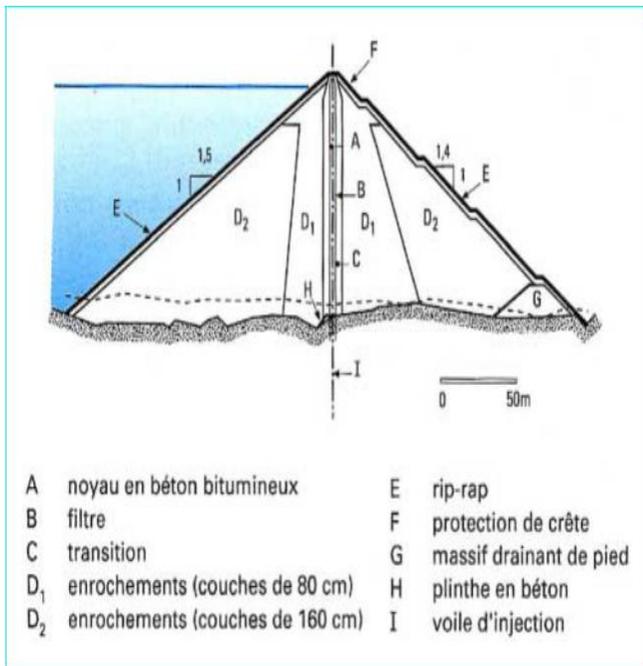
Barrage à noyau bitumineux de Storglomvatn (Norvège)
